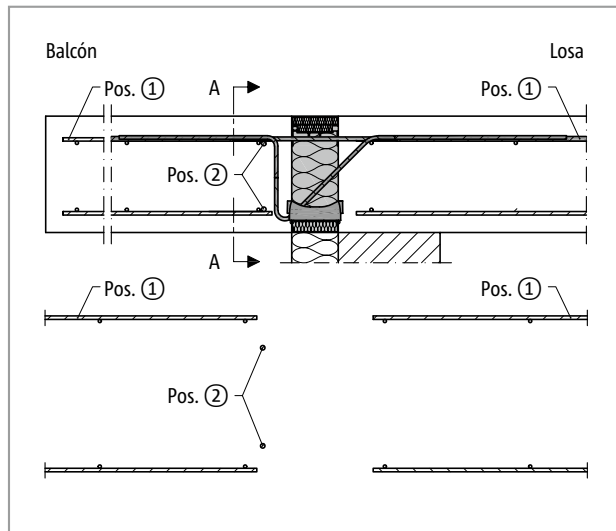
Schöck Isokorb® T tipo K-M1 hasta M11: Armadura in situ en caso de apoyo directo
